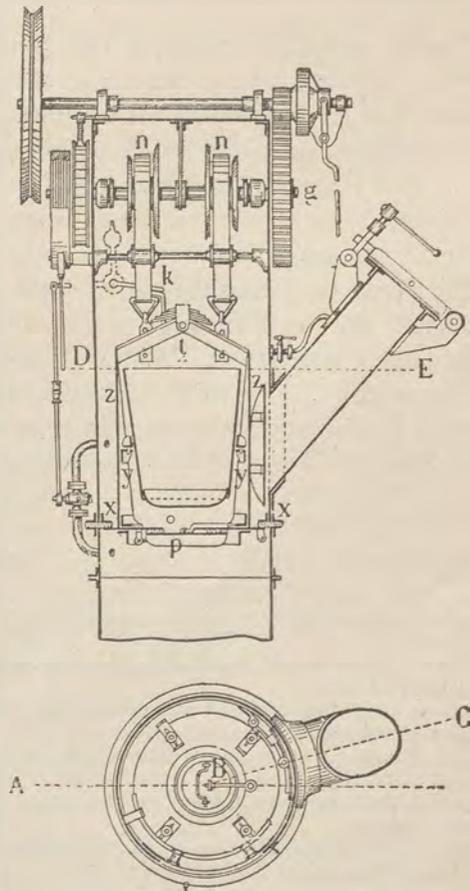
La camera di equilibrio dell'ing. Zschokke nelle fondazioni ad aria compressa.
